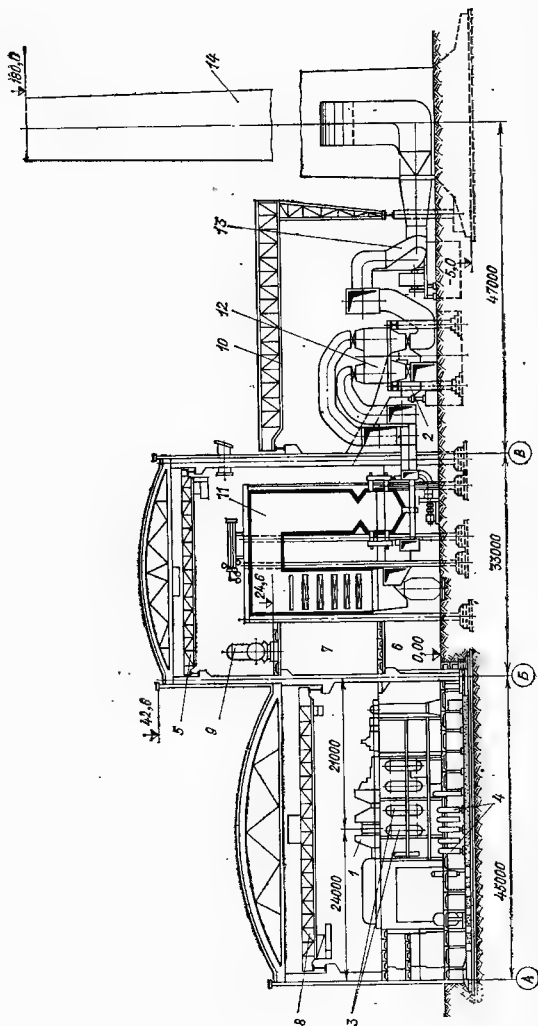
Компоновка главного корпуса с разворотом толка газомазутного котла к наружной стене (поперечный разрез):
